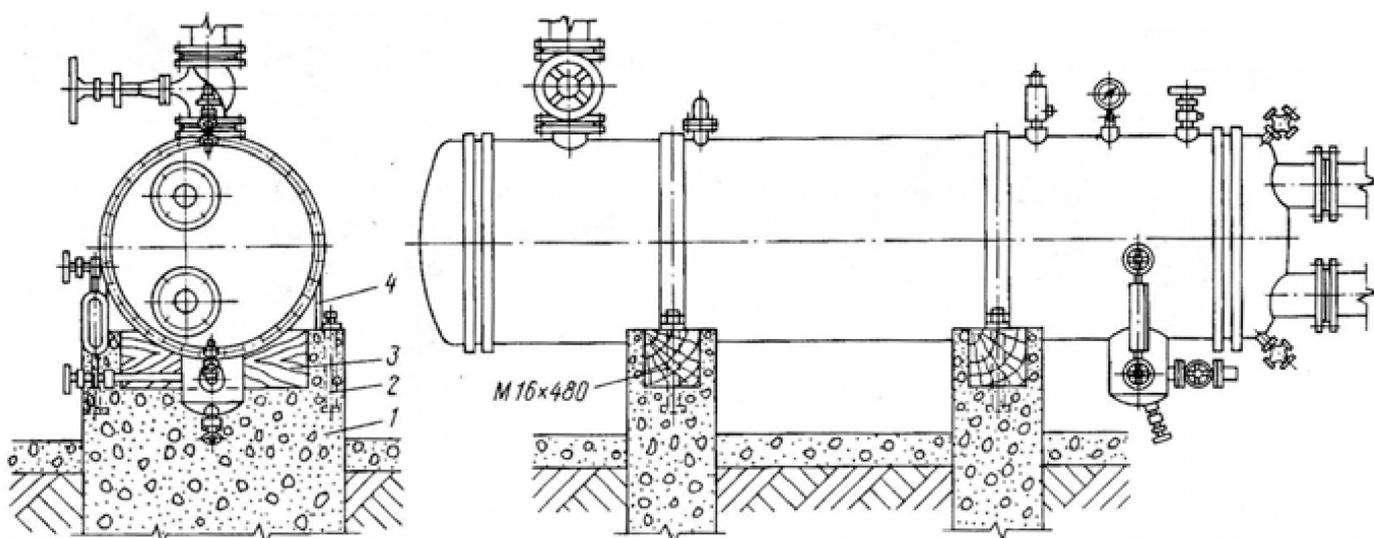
Размещение на фундаменте кожухотрубного конденсатора:
